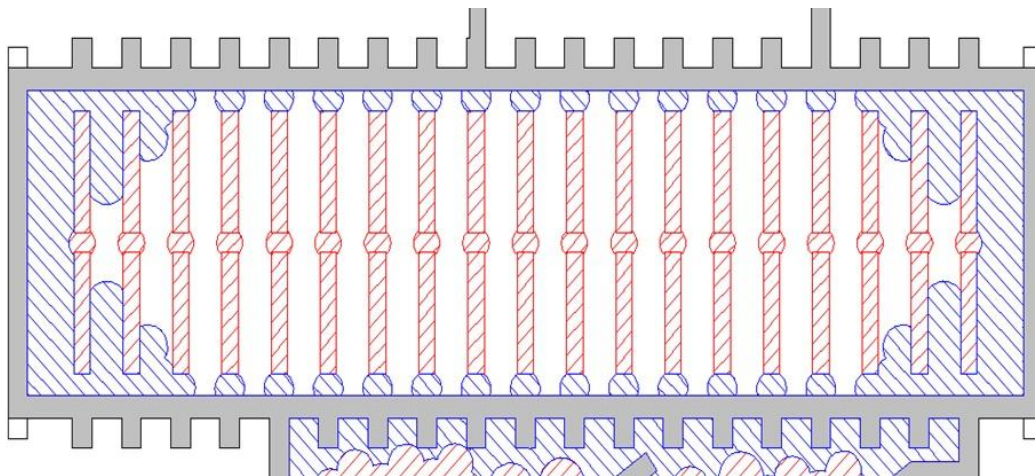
Solution retenue – Paroi moulée avec clavage en jet grouting
